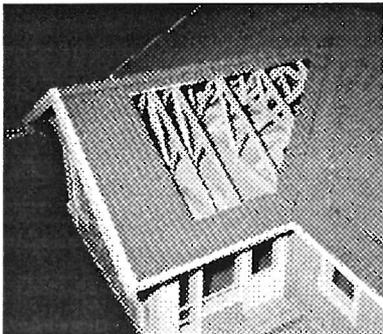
Blick in das Dach eines 1-geschossigen Einfamilienhauses
